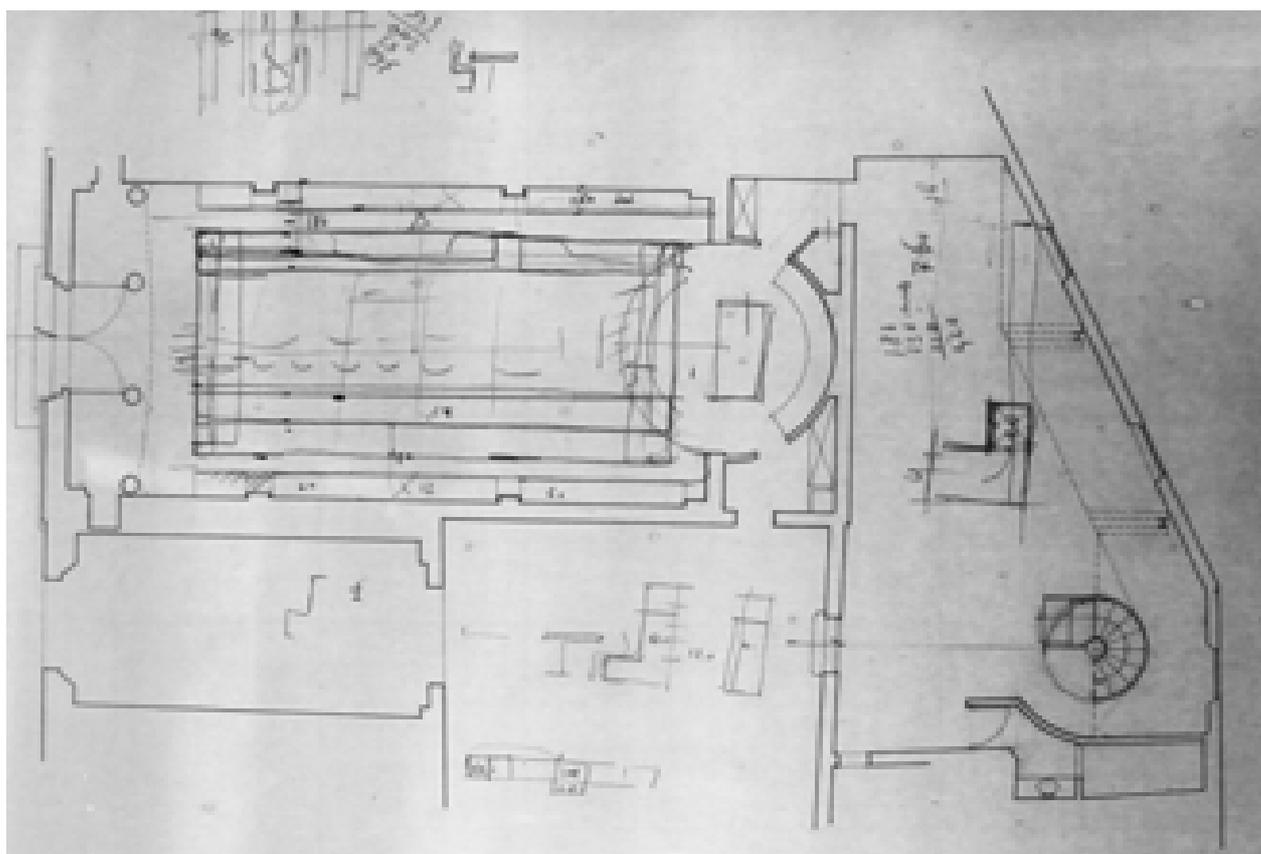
San Leonardo, sistemazione piano terra – s.d. (AABS-94.135)
